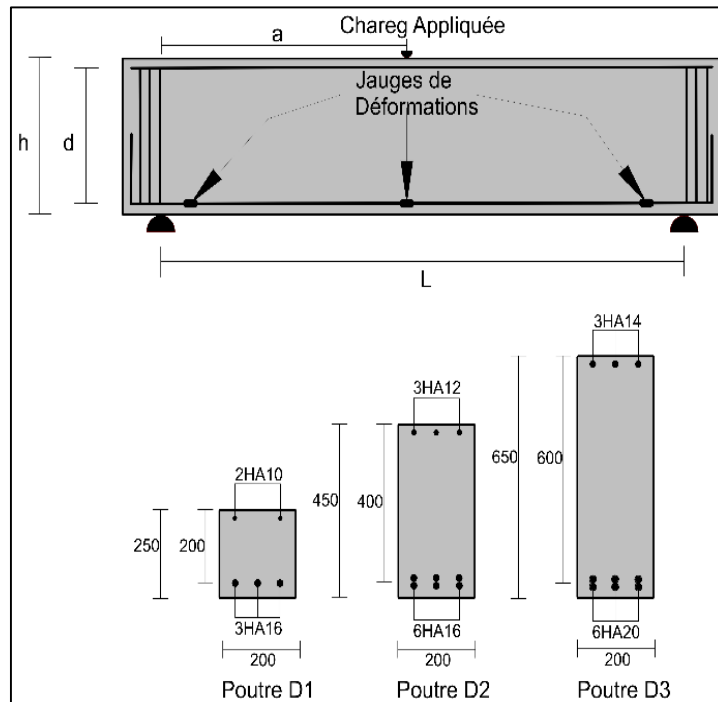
Détails de ferrailage des poutres testées (Dimensions en mm).
